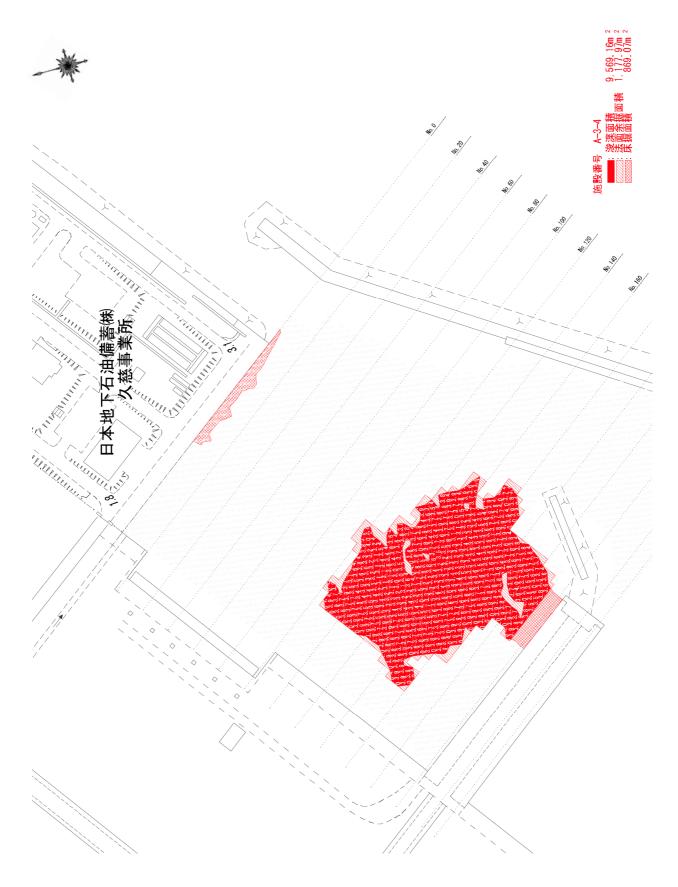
No.1 半崎地区_1号泊地埋設堆積状況平面図(被災後)
